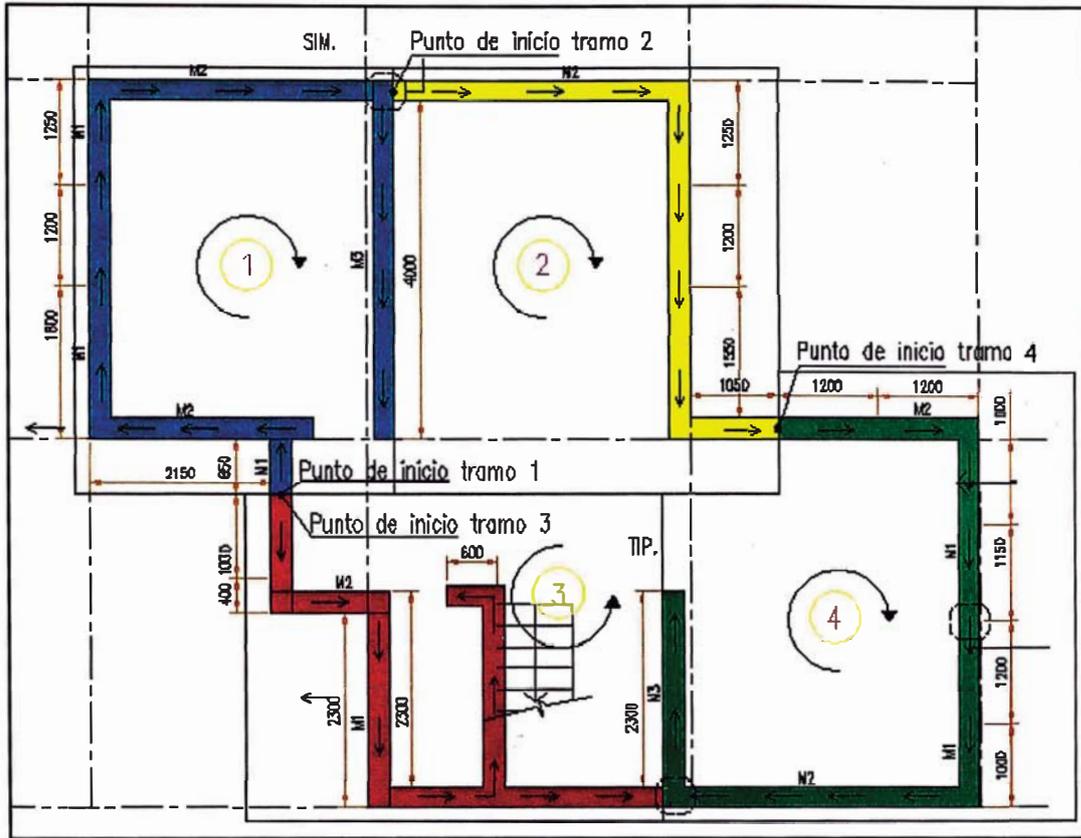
Secuencia de vaciado de concreto en muros y losa primer piso de la vivienda tipo 1R.
